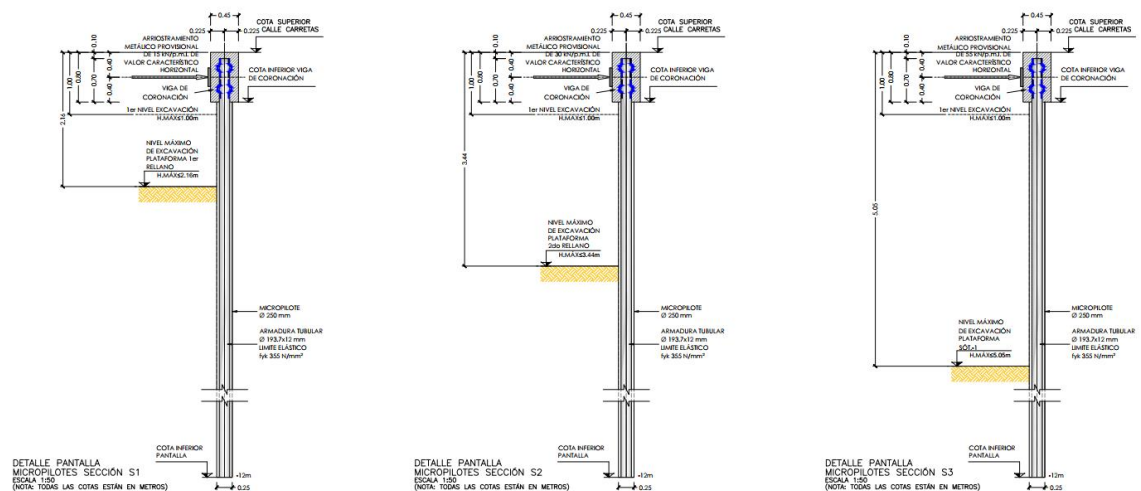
Sección S1, S2 y S3 de pantallas de micropilotes donde se identificar las alturas máximas de excavación.
